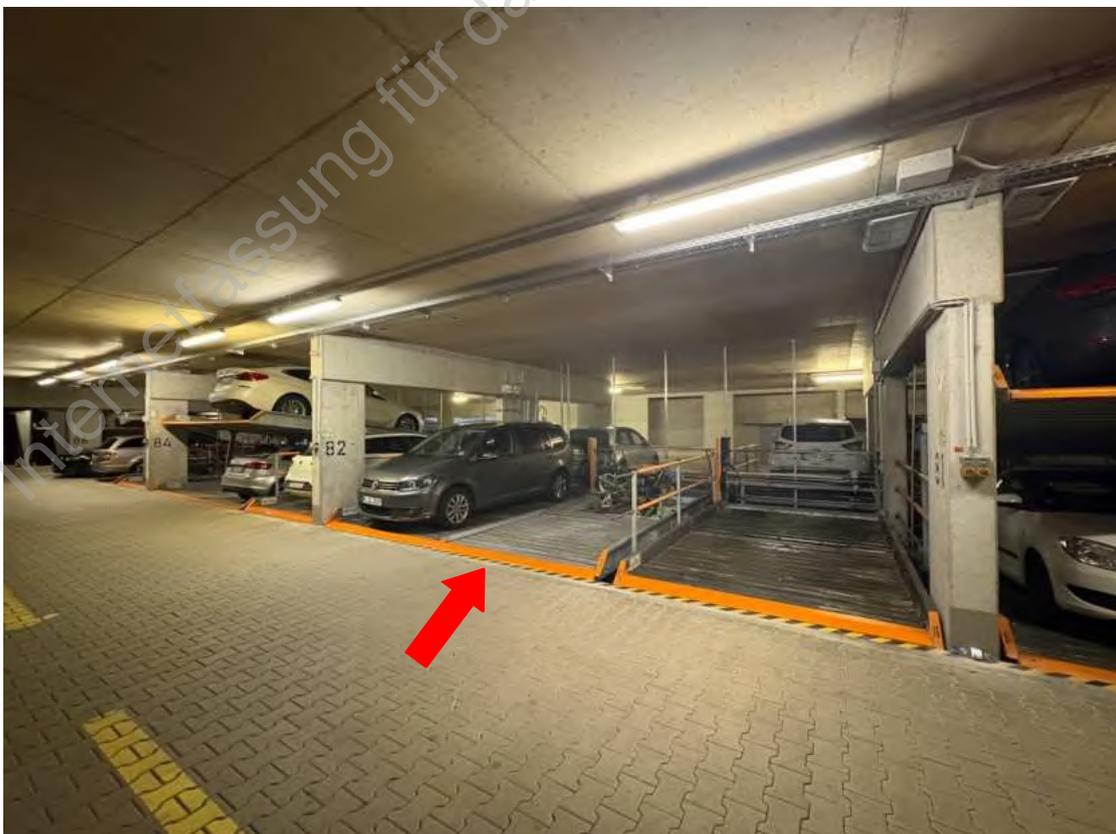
Stellplatz rechts/oben im Vierfachparket Nr. 82
